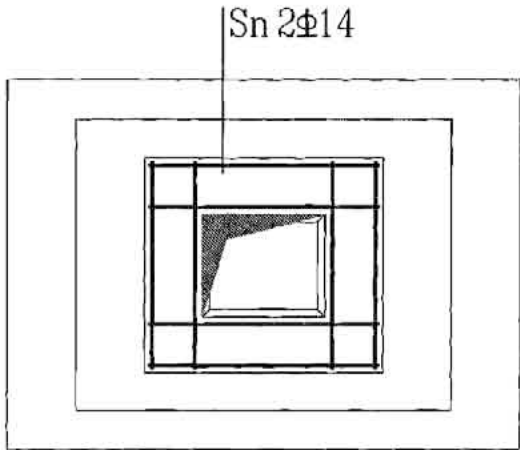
单杯口独立基础顶部焊接钢筋网示意
